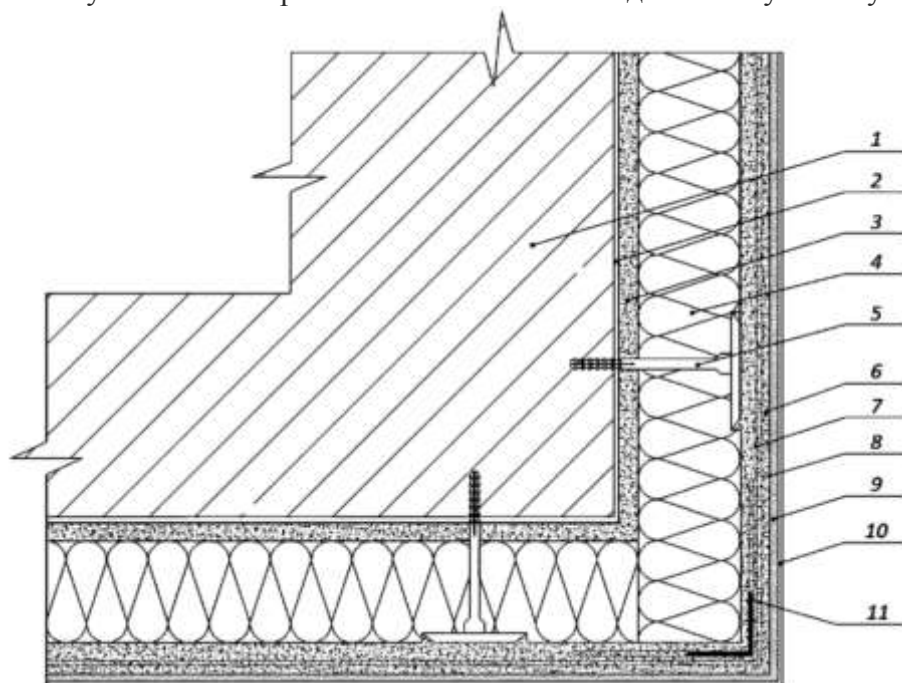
Примыкание системы к плоской кровле с выносным парапетом
